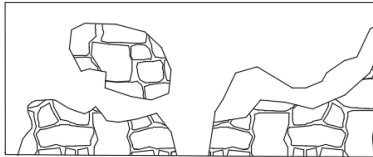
Detalles de actuación sobre terraza de planta primera. Fuente: CAD propio
